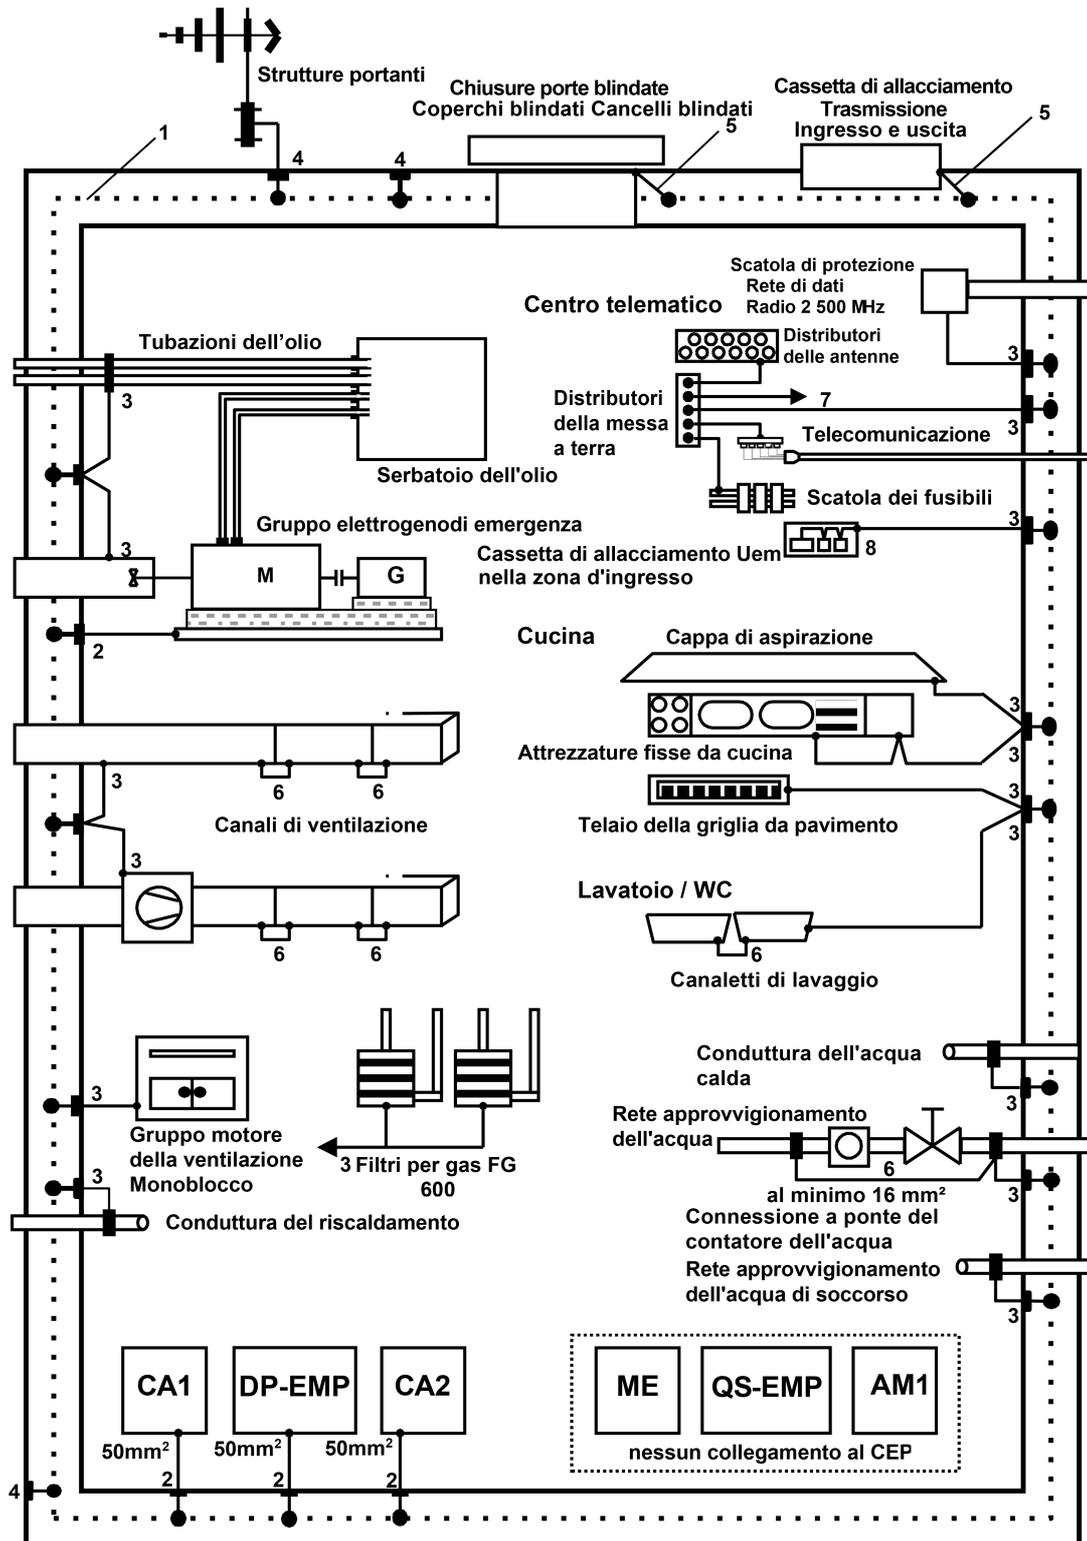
Punti di connessione senza protezione EMPSezione A-A
